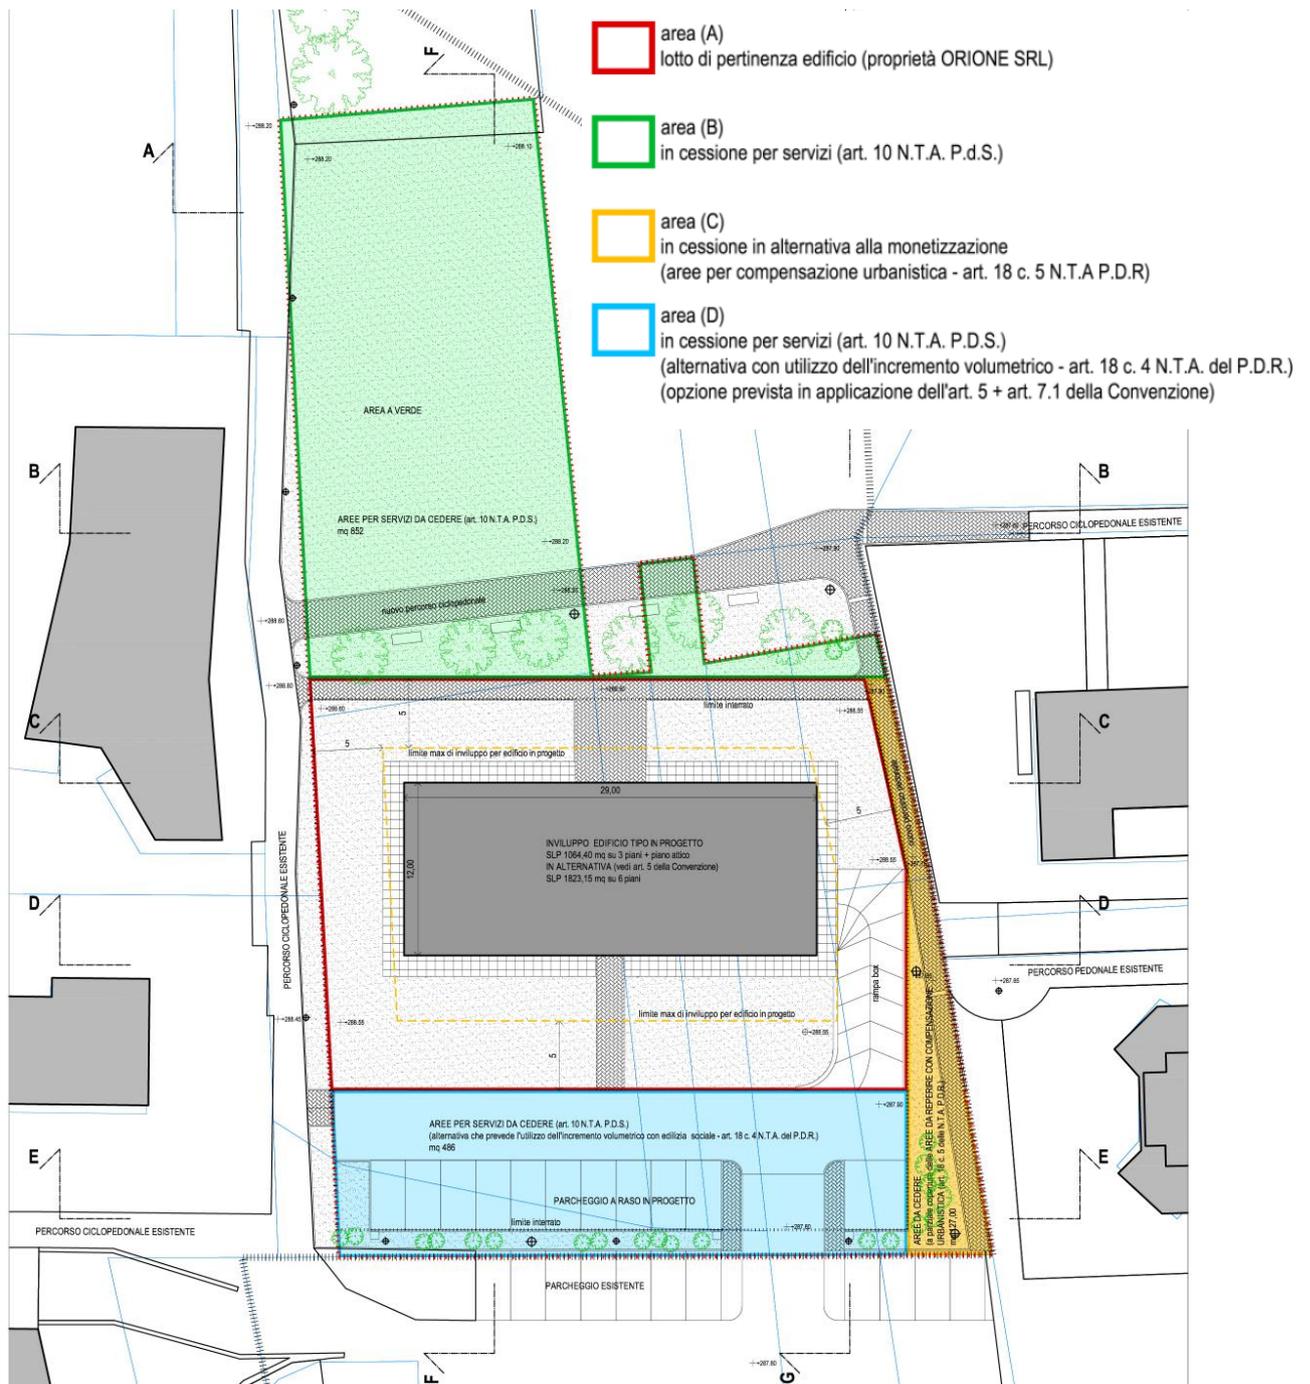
Estratto dalla tavola P.5 “Planimetria di progetto e sezioni schematiche”
